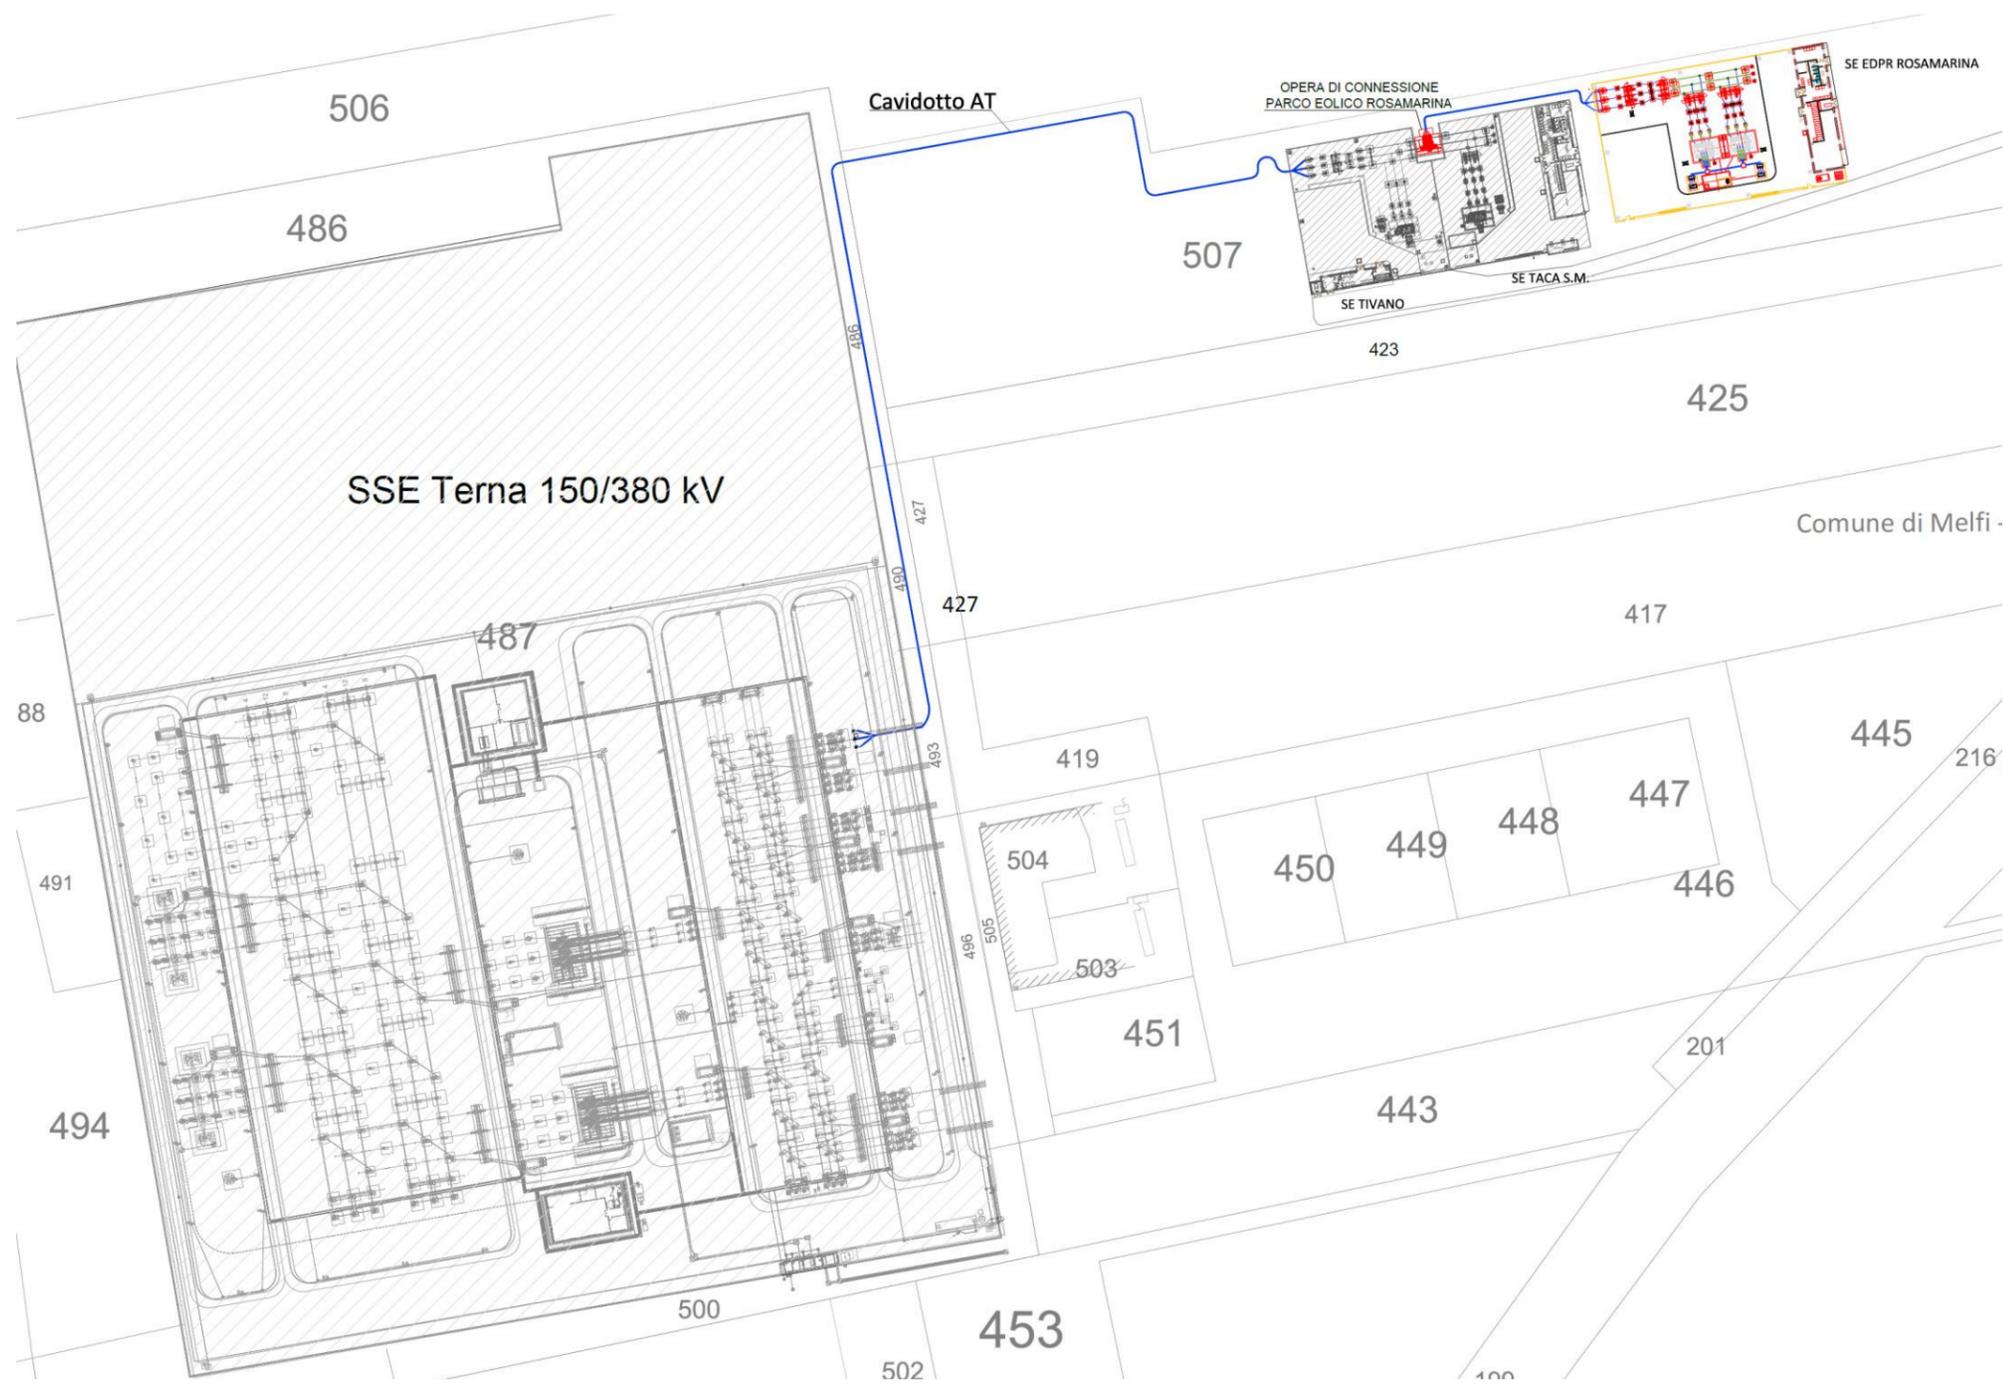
Stralcio planimetrico area SSE Terna e stazione Utente su catastale
